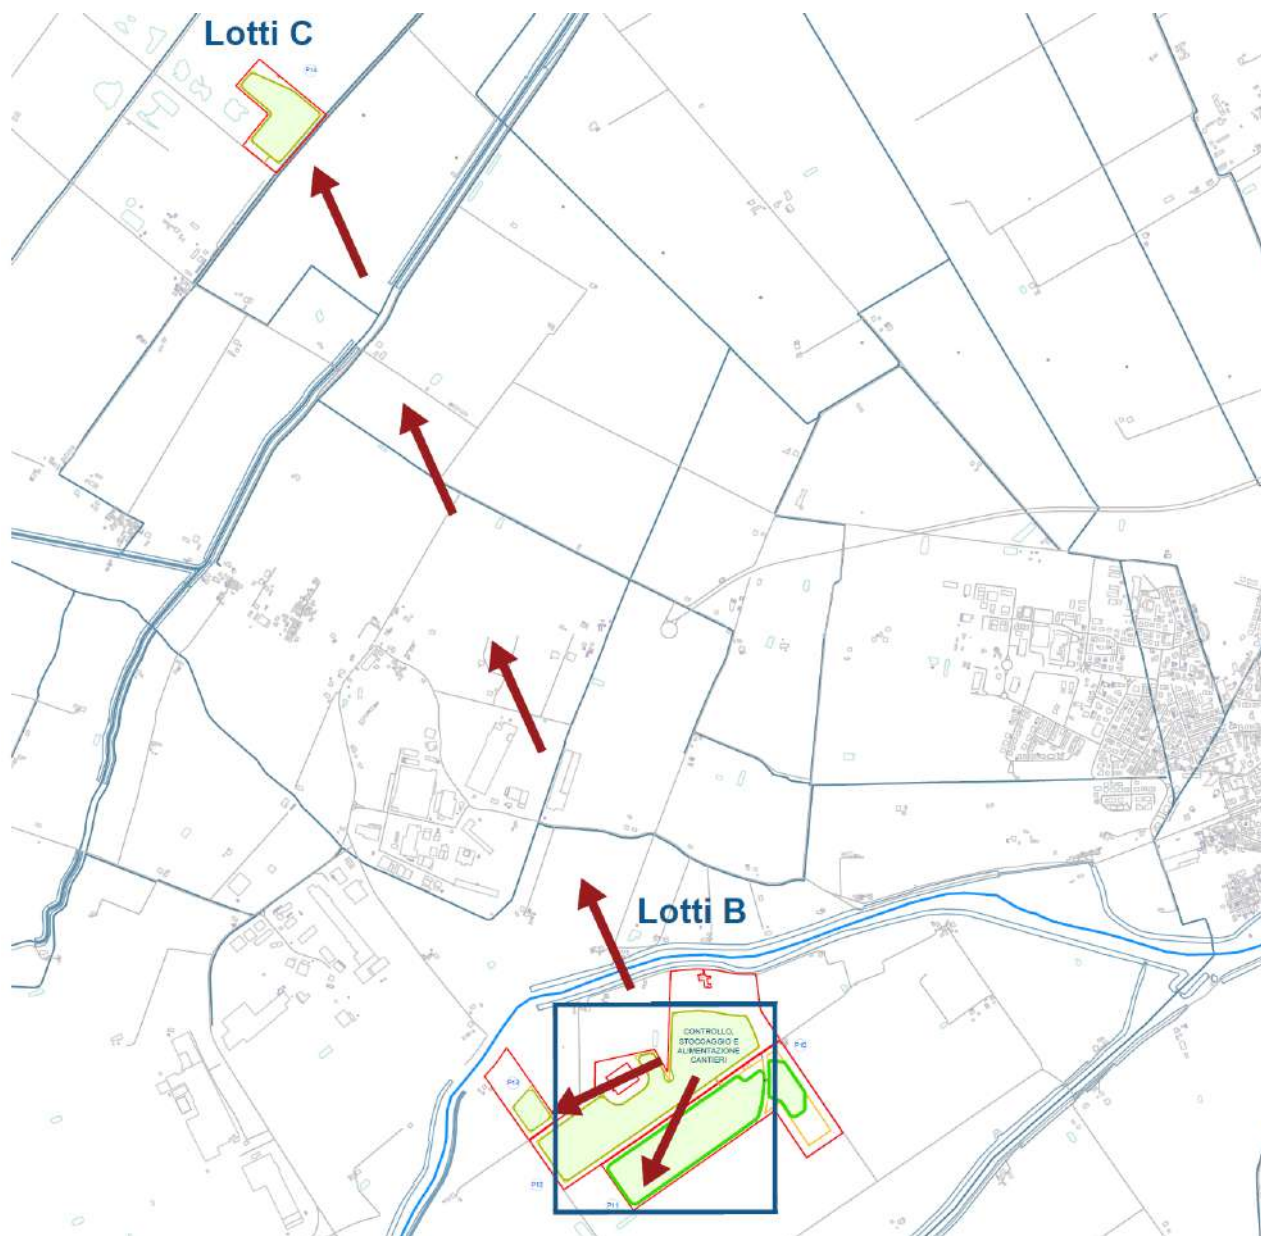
Schema generale (Fonte: relazione E\_R10\_Piano di cantierizzazione)
